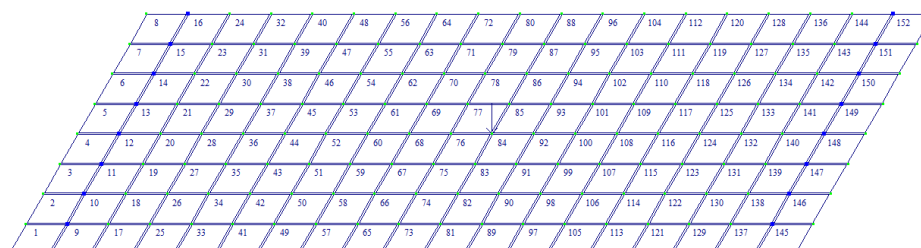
Загальний вигляд розрахункової схеми багатопустотної плити
